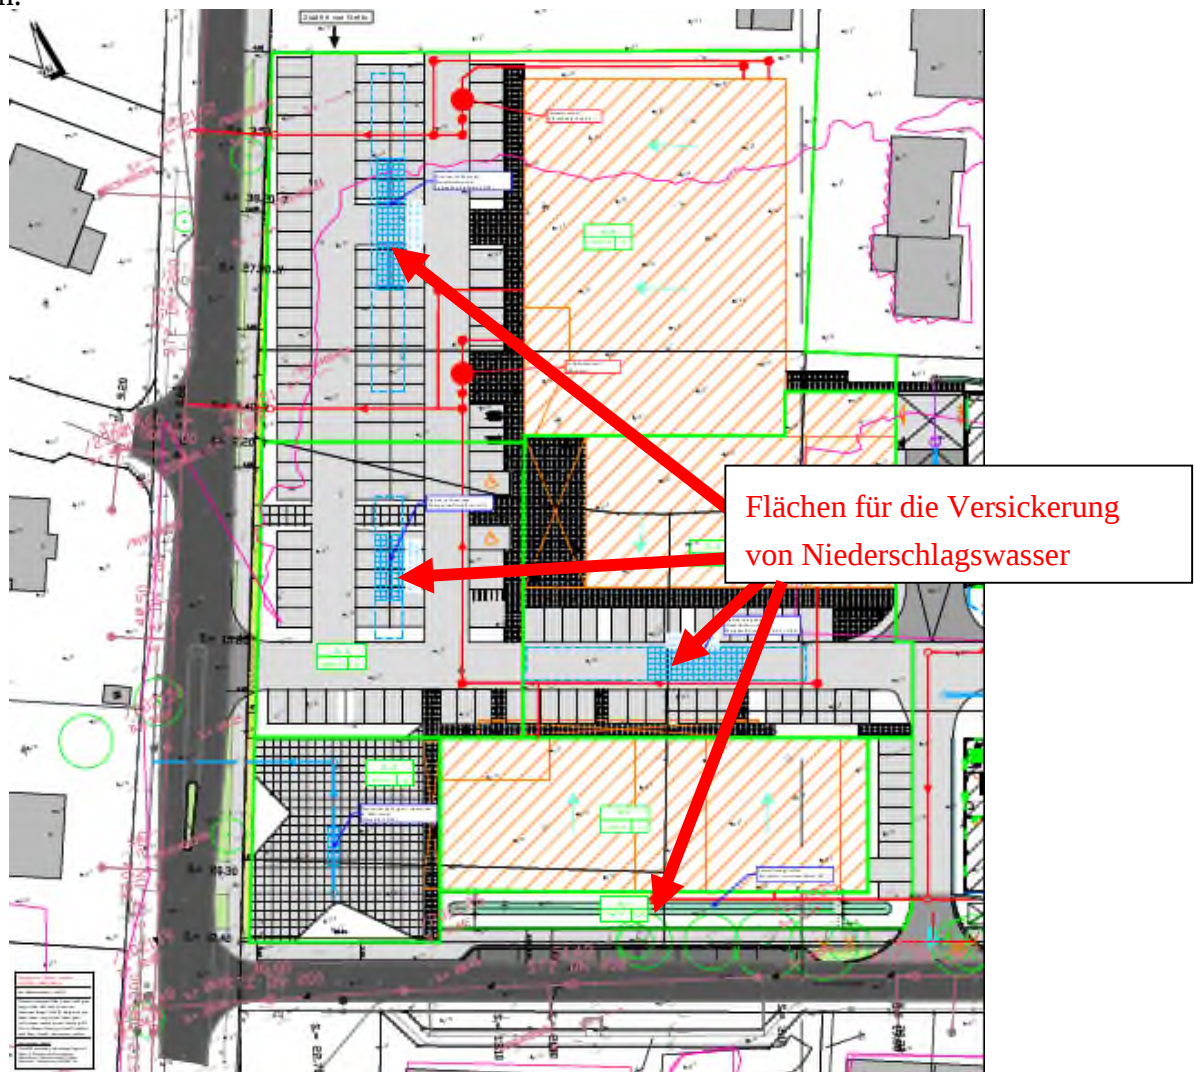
Ausschnitt aus (3), Lageplan Entwässerung Bereich vorhabenbezogener B-Plan
